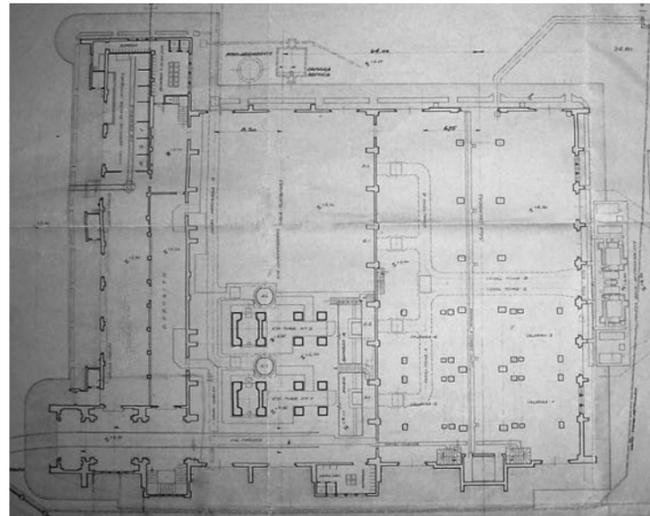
| Redibujo esquemático de la planta de la Usina Ingeniero White, luego General San Martín. Fuente: autoría propia.
